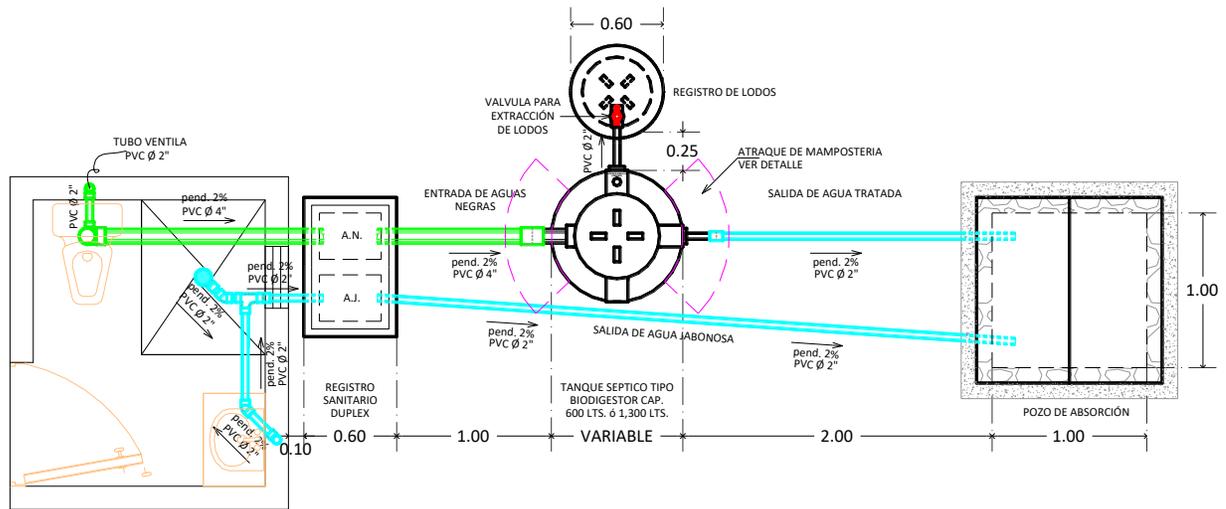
Instalación sanitaria de tratamiento. Módulo de Saneamiento "A" - Vista en planta.
